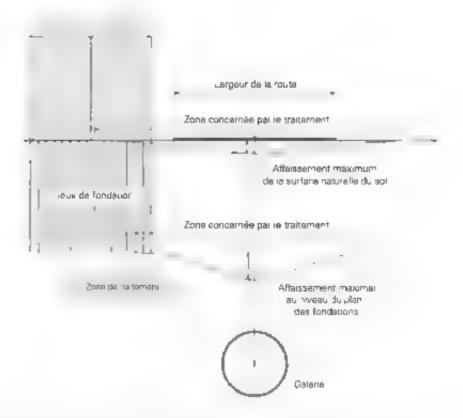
Exemple d'injection de compensation (compensation grouting) pour compenser les affaissements induits par l'excavation d'un tunnel du métro d'Amsterdam (modifié de Bezuijen et al., 2011).
